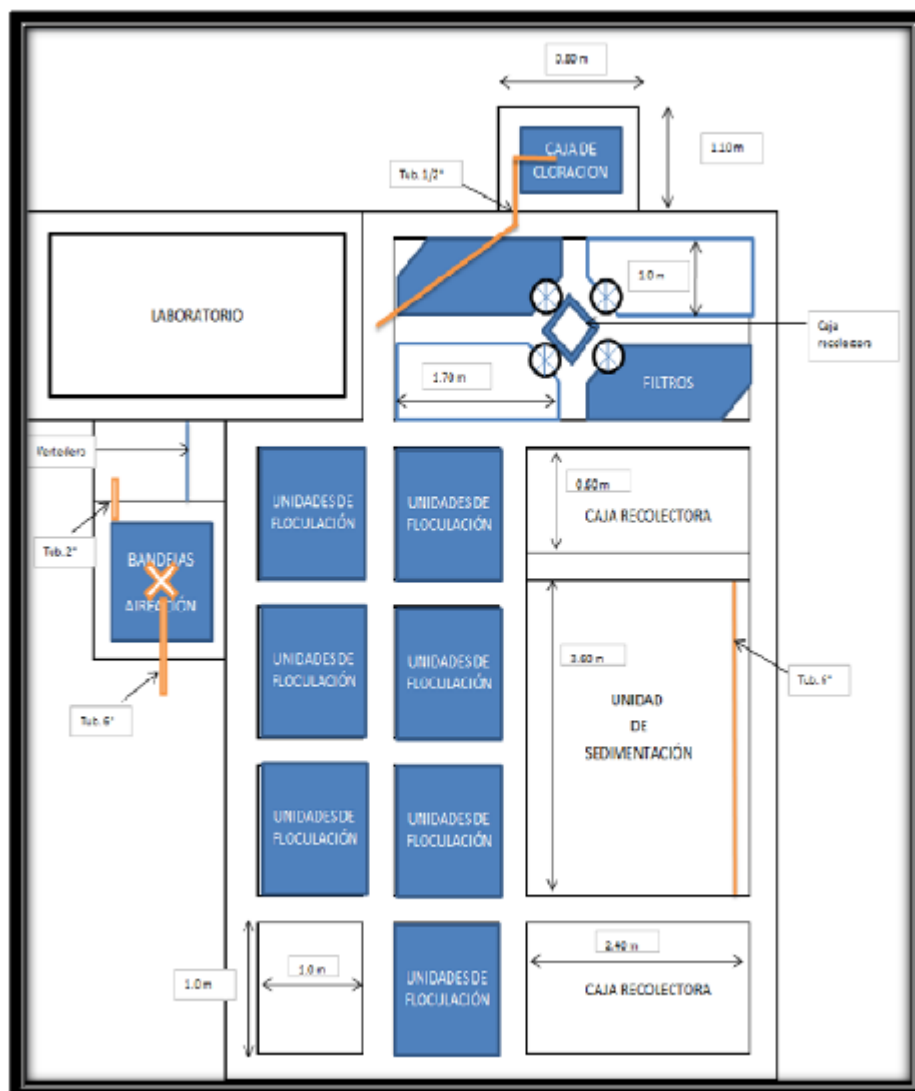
Detalles Planta de Tratamiento de Agua Potable.
